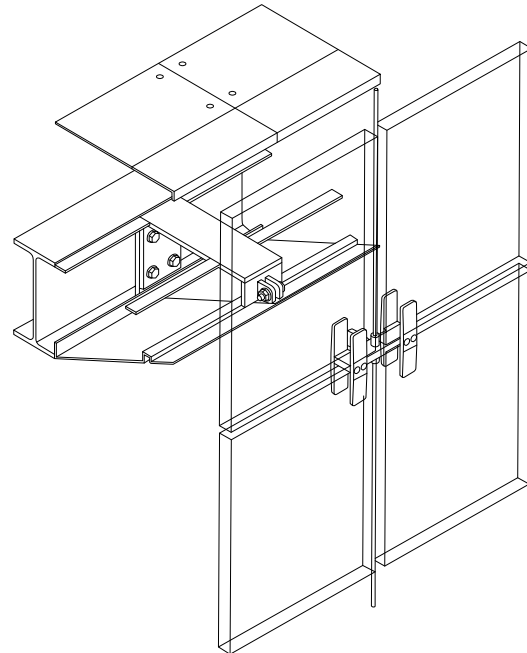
R128_DetalleFachada. Elaboración propia.
